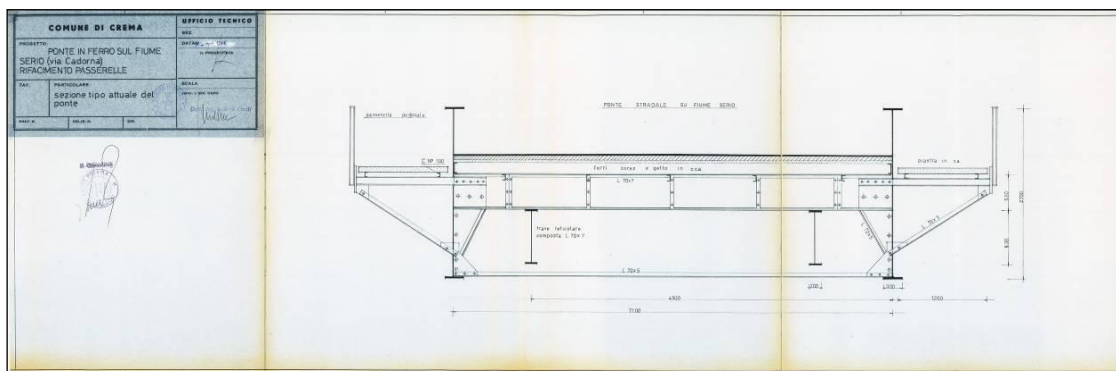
Sezione ripo del ponte – prima dell'intervento sulle passerelle
